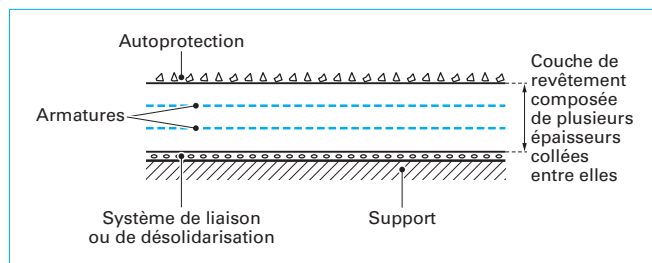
Divers constituants d'un revêtement d'étanchéité multicouche
